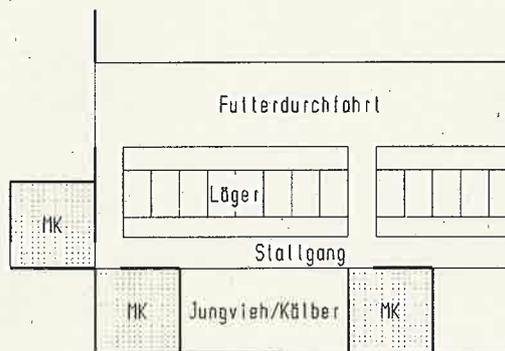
Die Milchammer soll für die Milchabfuhr leicht zugänglich sein.
